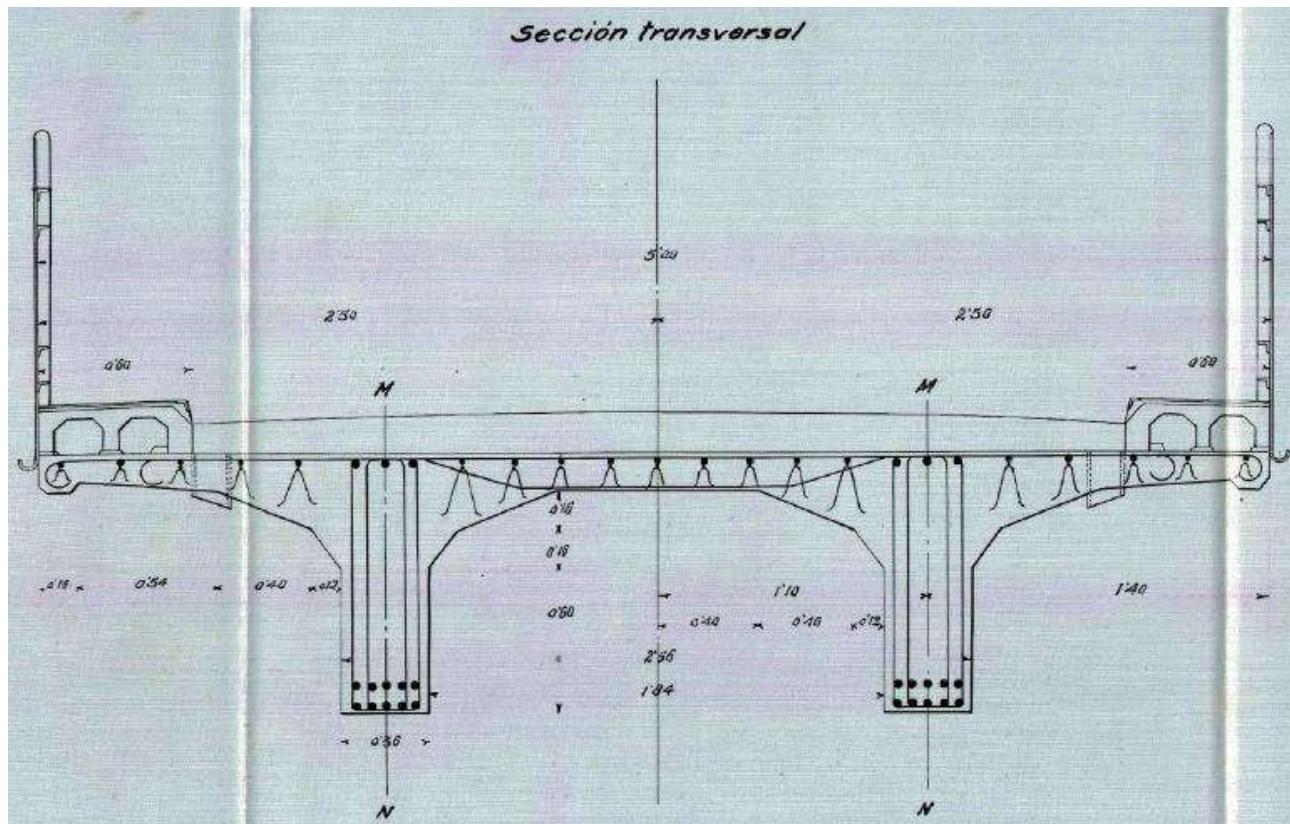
Sección tipo. Del Proyecto "Camí veïnal de Gelida a Sant Llorenç d'Hortons, BV-2249. Projecte reformat i pressupost addicional de les avingudes i pont de formigó armat sobre el riu Anoia: memòria, plànols i pressupost."
